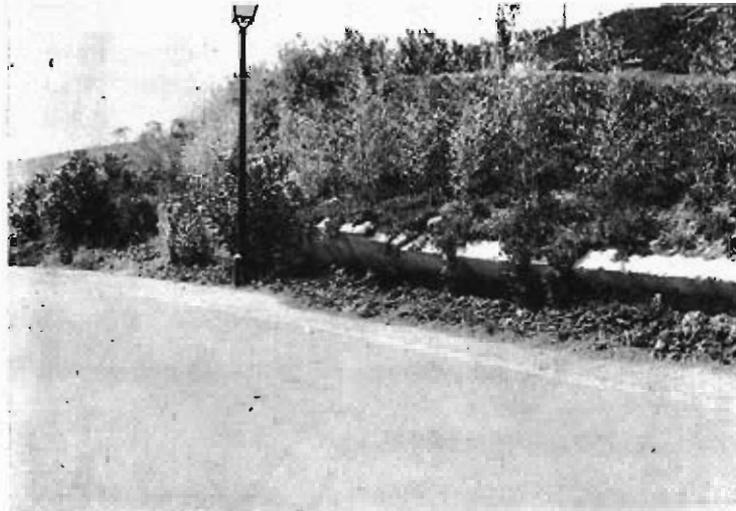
Muro de hormigón armado tumbado por el movimiento de las margas (312 h)
